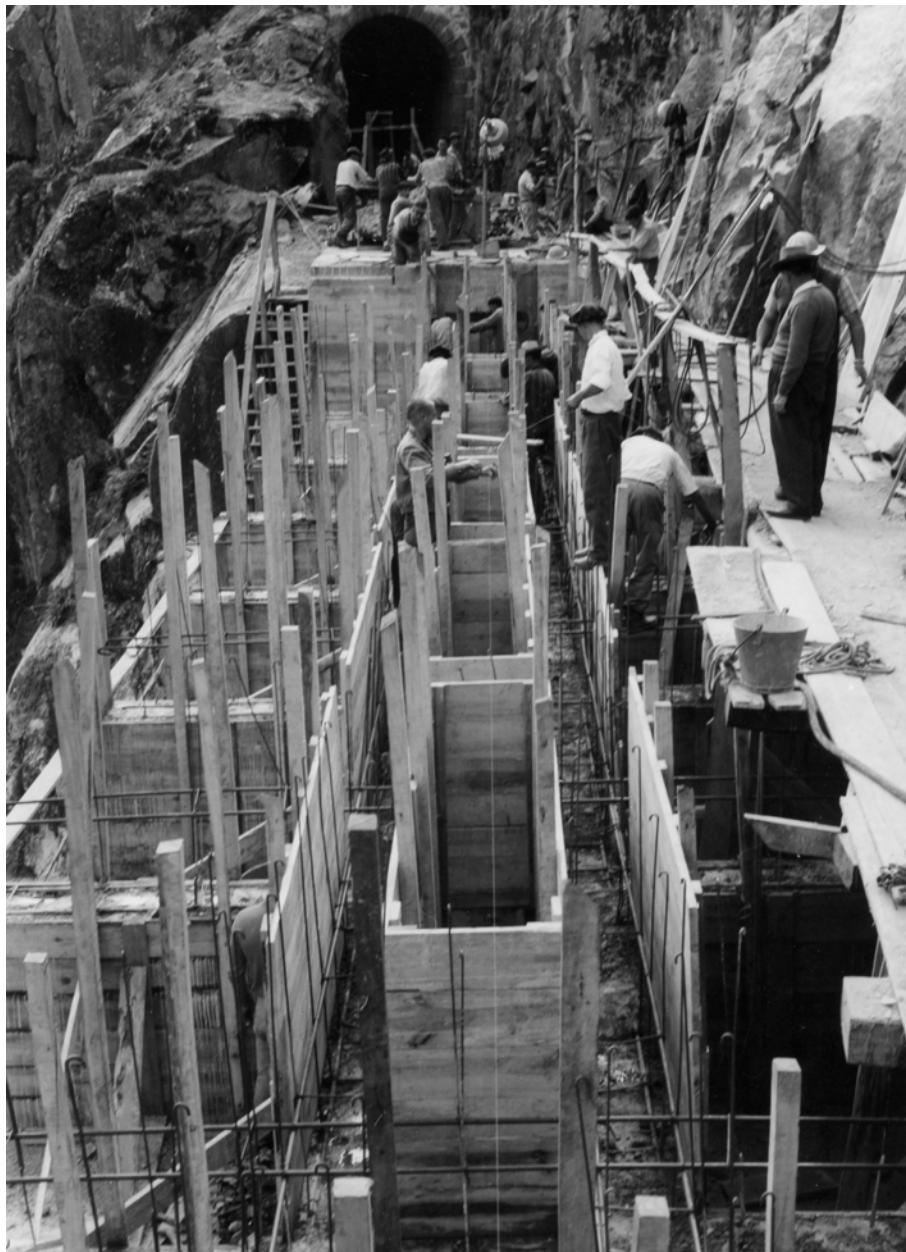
Viaduto das Fragas Más – cofragem da estrutura celular – 2ª betonagem de 1,20 m no tramo do lado da Foz do Tua (fonte: REFER)
